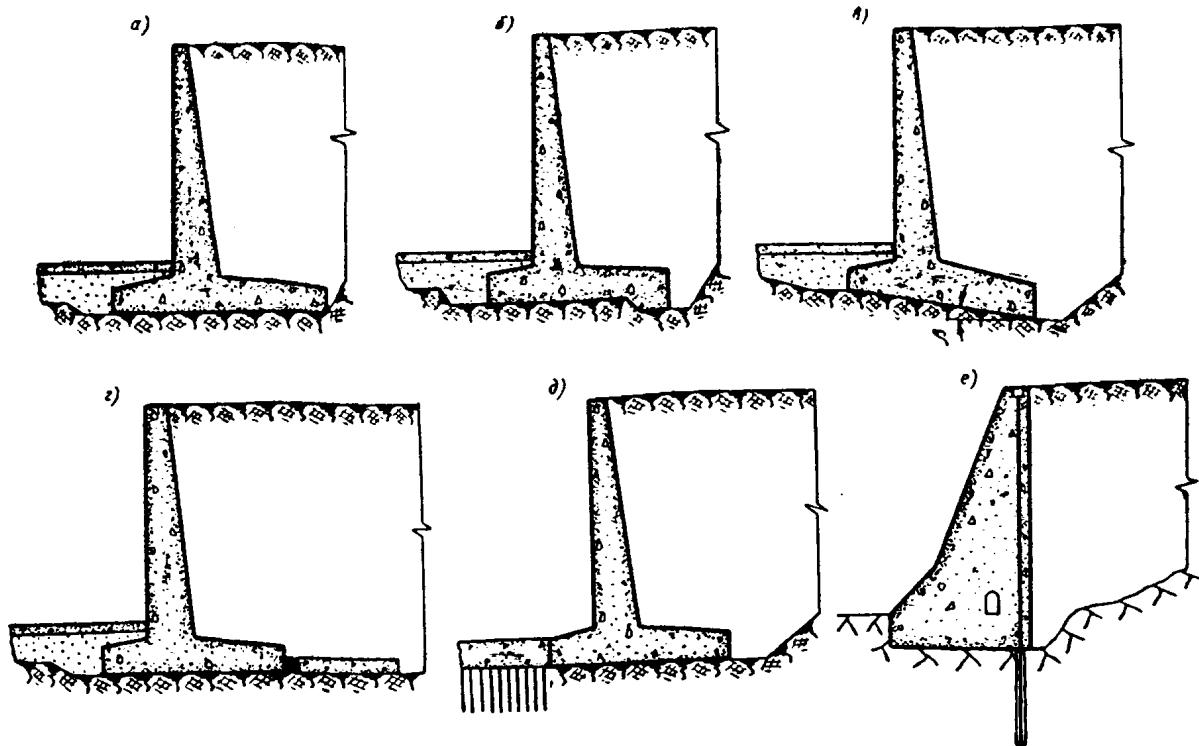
Конструктивные устройства для повышения устойчивости подпорных стен
